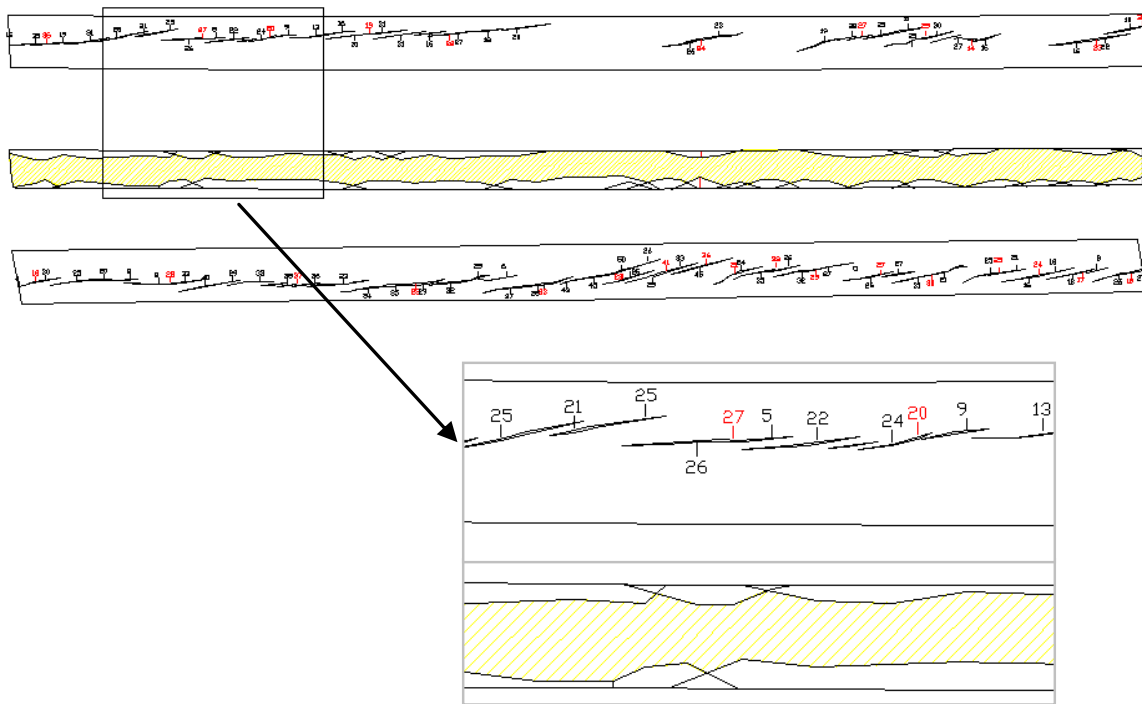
Esquema general y detalle del plano de rasante de una de las vigas
